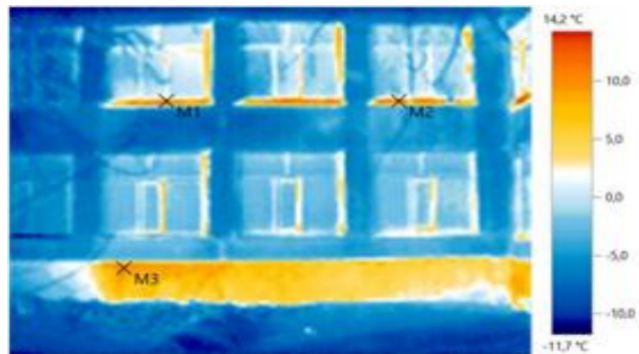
Зона сопряжения наружных стен с фундаментом
